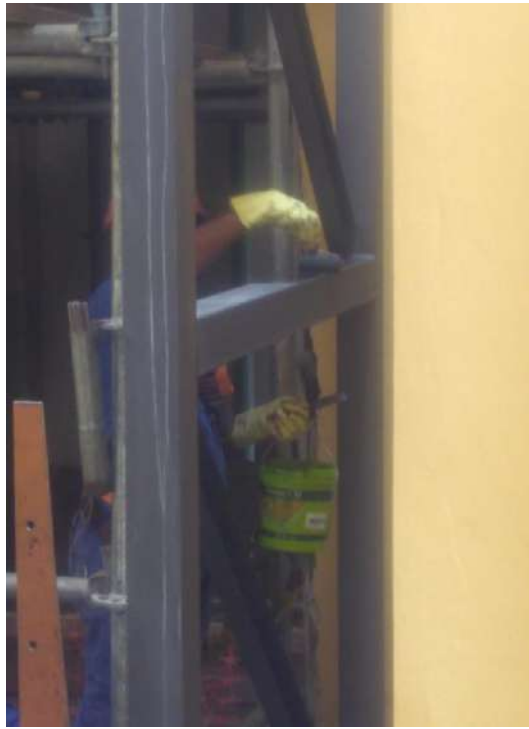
Execução da pintura lisa da estrutura metálica do elevador
